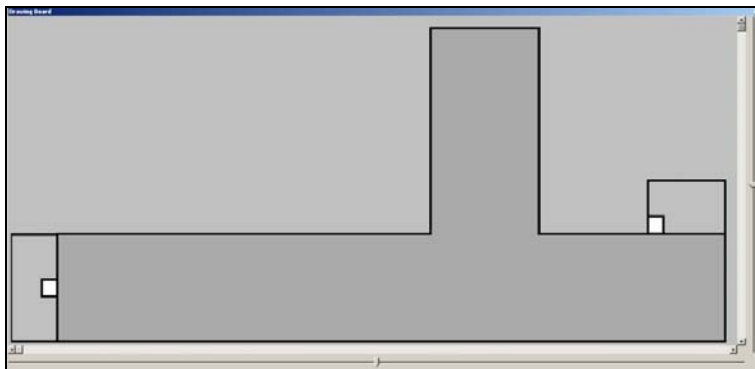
Rechtwinkliger Grundriss (dunkelgrau), Eiermann-Bau Apolda, EG
